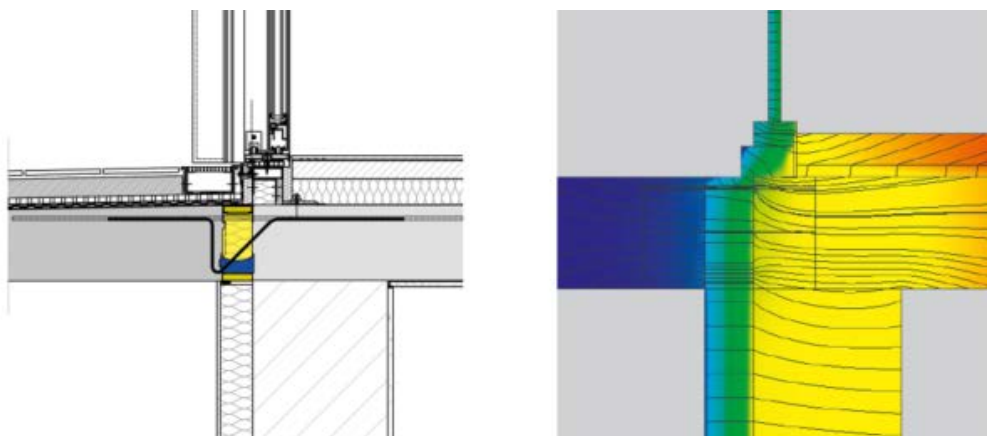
Taglio termico: Isokorb® è un elemento isolante e al tempo stesso assolve funzione strutturale. Il giunto permette il proseguimento uniforme ed omogeneo dell'isolamento della parete esterna, riducendo in tal modo al minimo il ponte termico. Il balcone non viene "riscaldato" e il calore resta all'interno della stanza, garantendo così la massima efficienza energetica.
